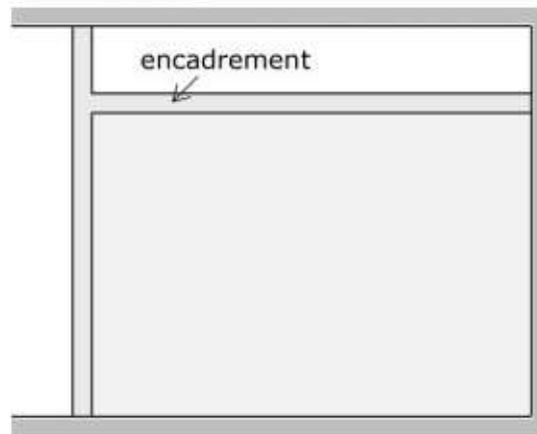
encadrement des cloisons n'atteignant pas le plafond
